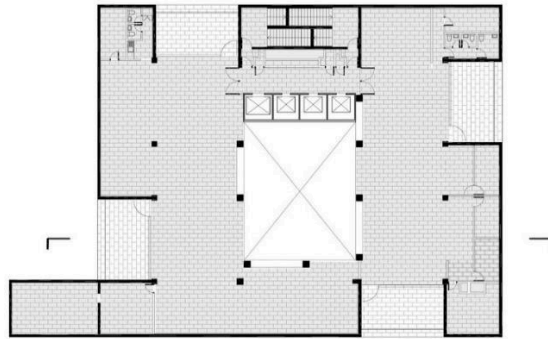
Planta baixa recepção. Centro de Inovação UC – Chile.
